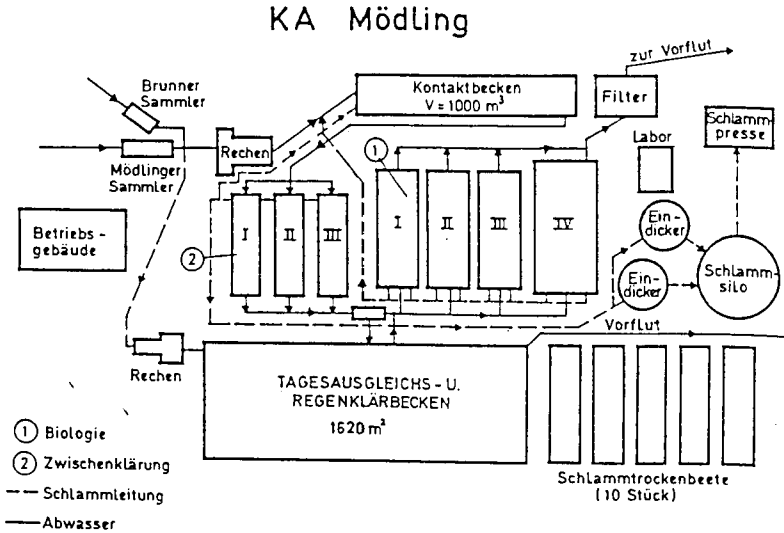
Lageplan der Kläranlage Mödling vor Erweiterung
